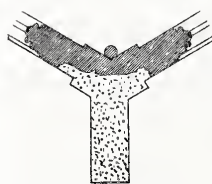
Grundriß in Höhe H₁.Abb. 2. Grundriß in Höhe H₂.
